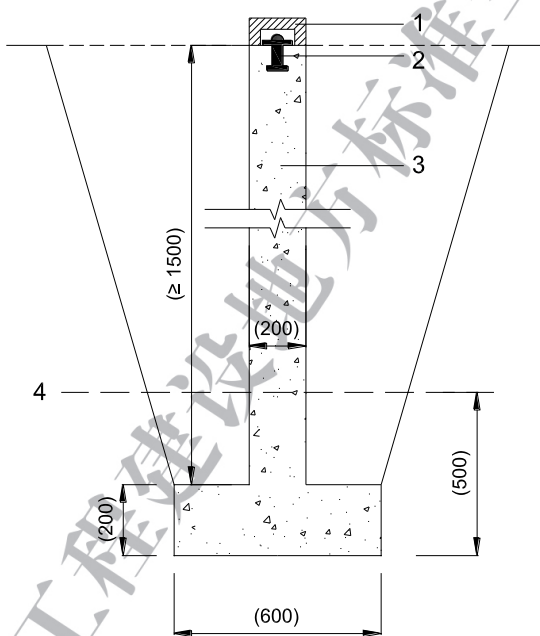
混凝土普通水准点标石埋设 (单位: mm)
